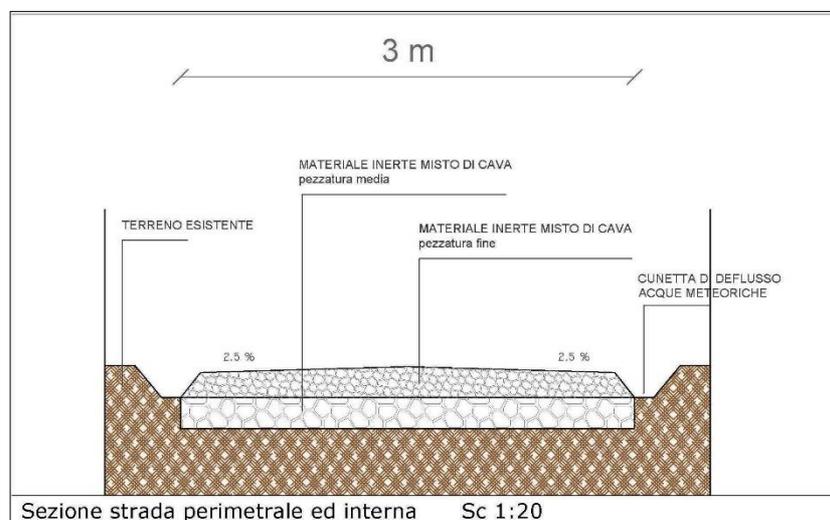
sezione della viabilità interna e perimetrale dell'impianto;
